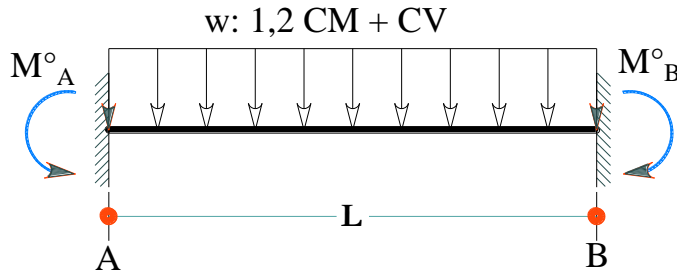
Esquema de cálculo de la fuerza cortante en vigas
